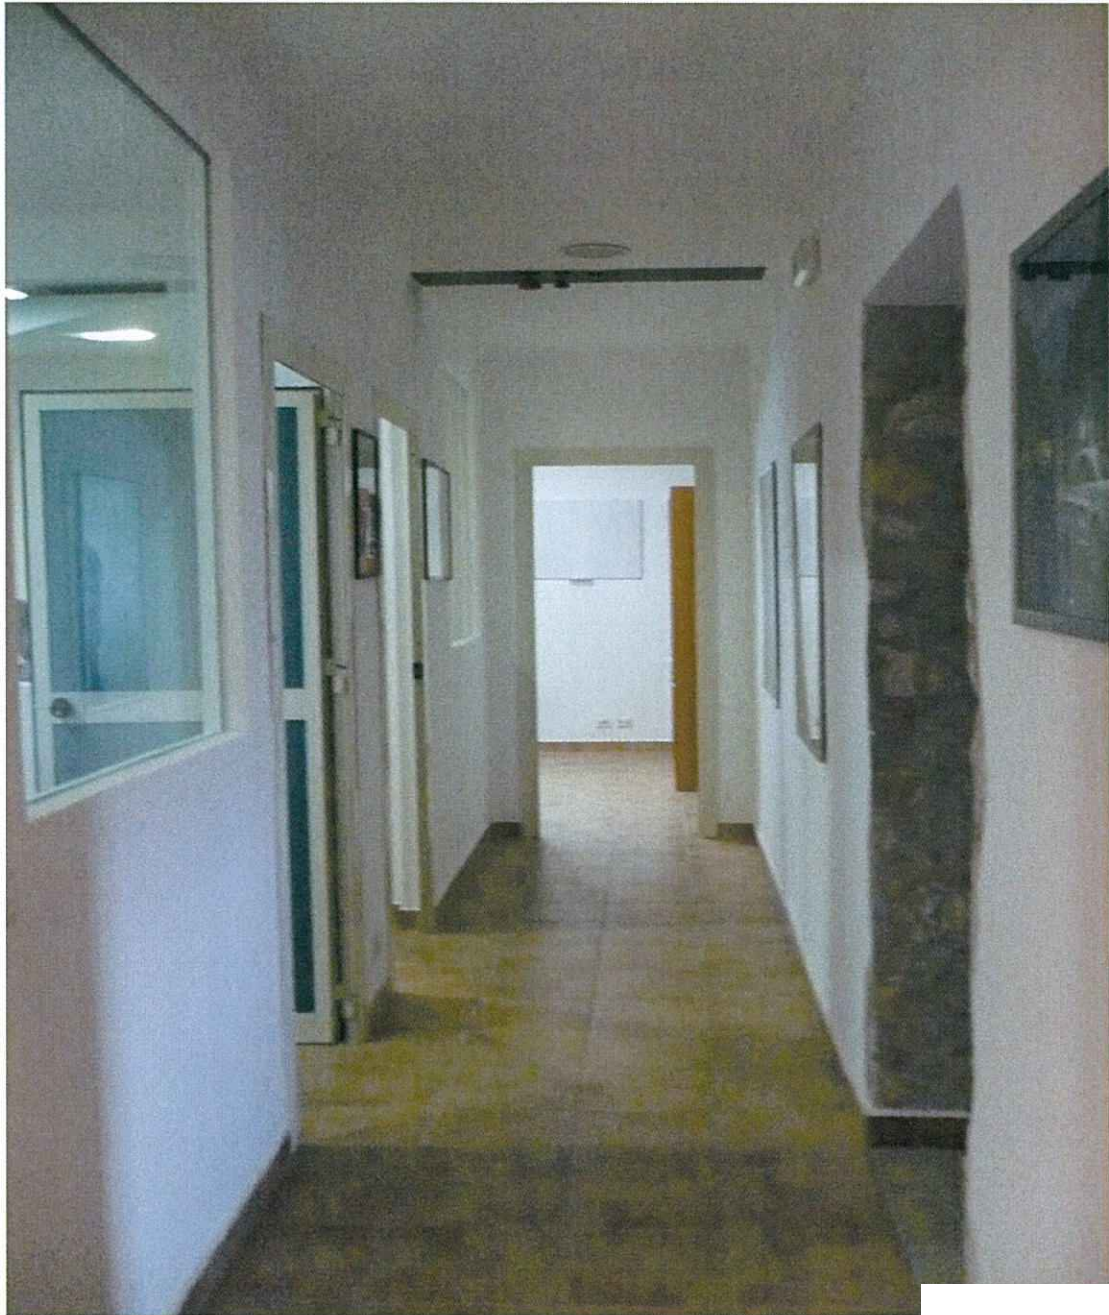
FOTO INTERNA: CORRIDOIO (CORPO INTERMEDIO)
